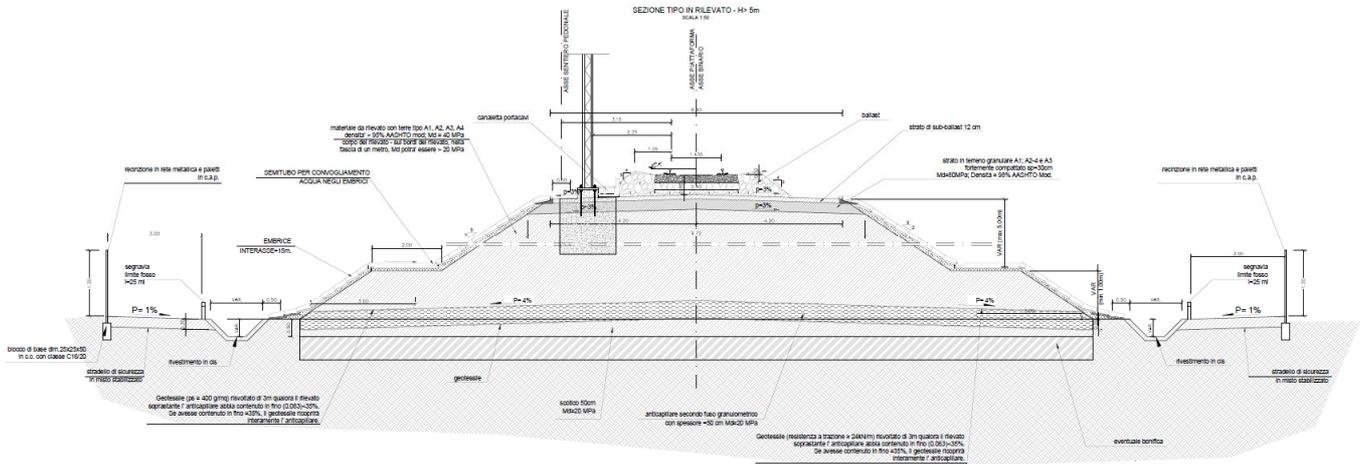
Corpo stradale ferroviario - Sezione tipo in rilevato - altezze > di 5m
